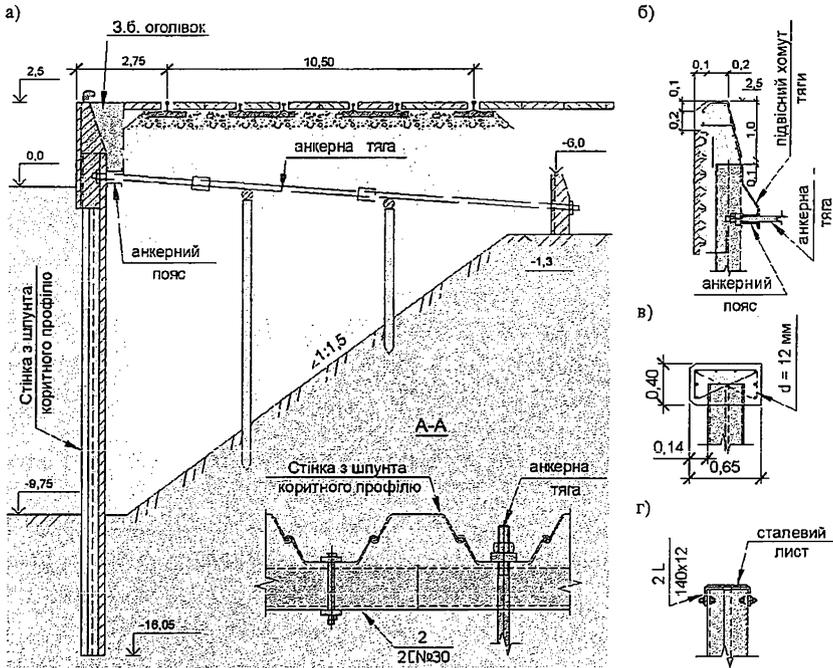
Набережні-стілки на залізобетонних пальях з переднім шпунтом
